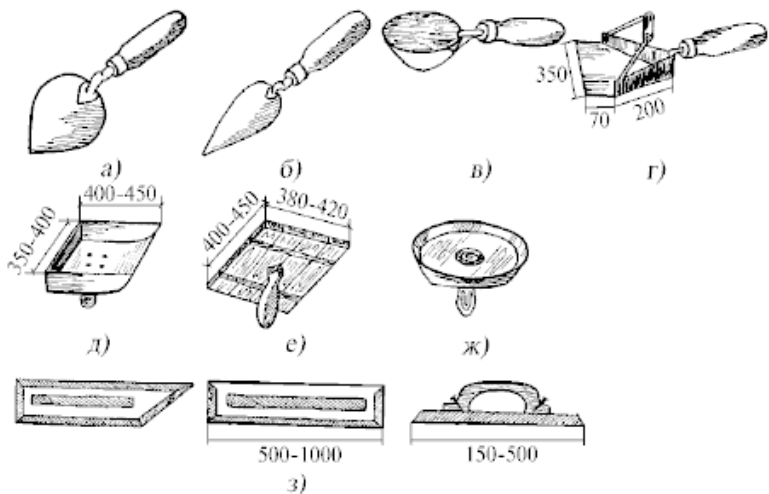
Инструменты для нанесения и разравнивания раствора: а) штукатурная лопатка; б) отрезовка; в) ковш; г) совок с качающейся ручкой; д) совок-ковш; е) прямоугольный сокол; ж) тарельчатый сокол; з) полутерки
